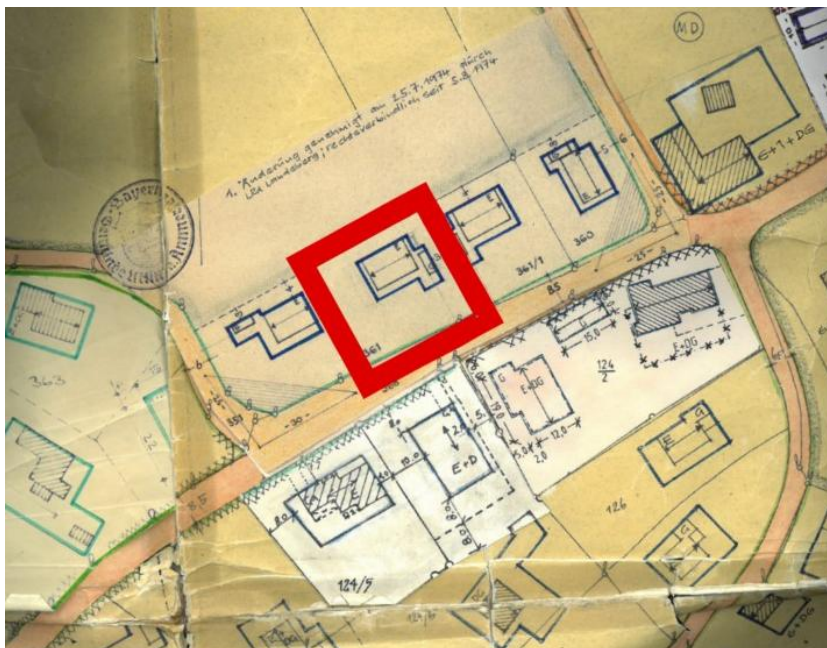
1. Änderung des Bebauungsplanes Holzhausen-West genehmigt am 25.07.1974 und der Geltungsbereich der 16. Änderung, ohne Maßstab
